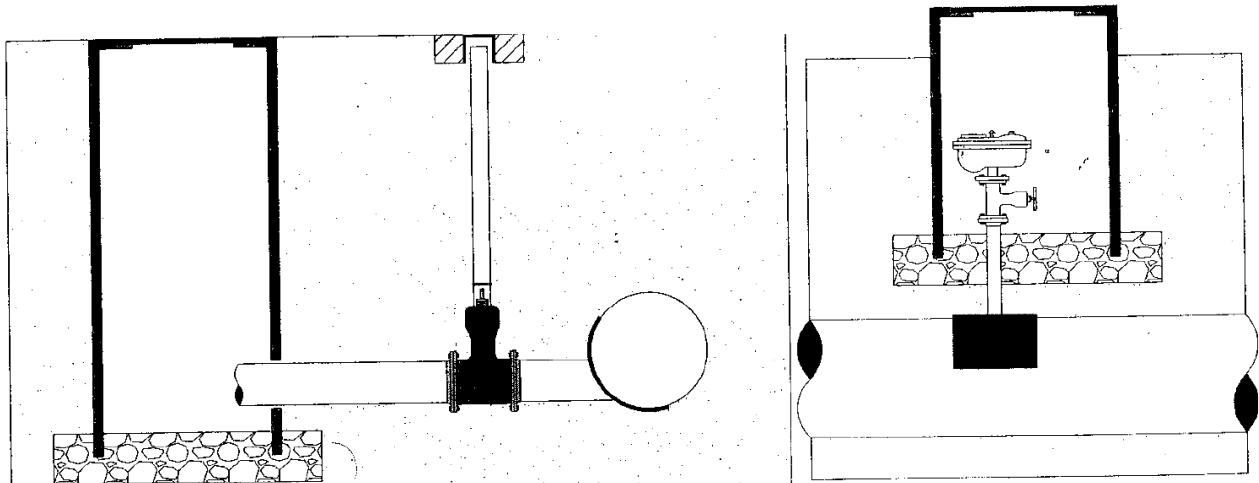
Coupe-type d'un ouvrage de vidange (gauche) et un ouvrage de ventouse (droite)- Source : Atlantic'eau
